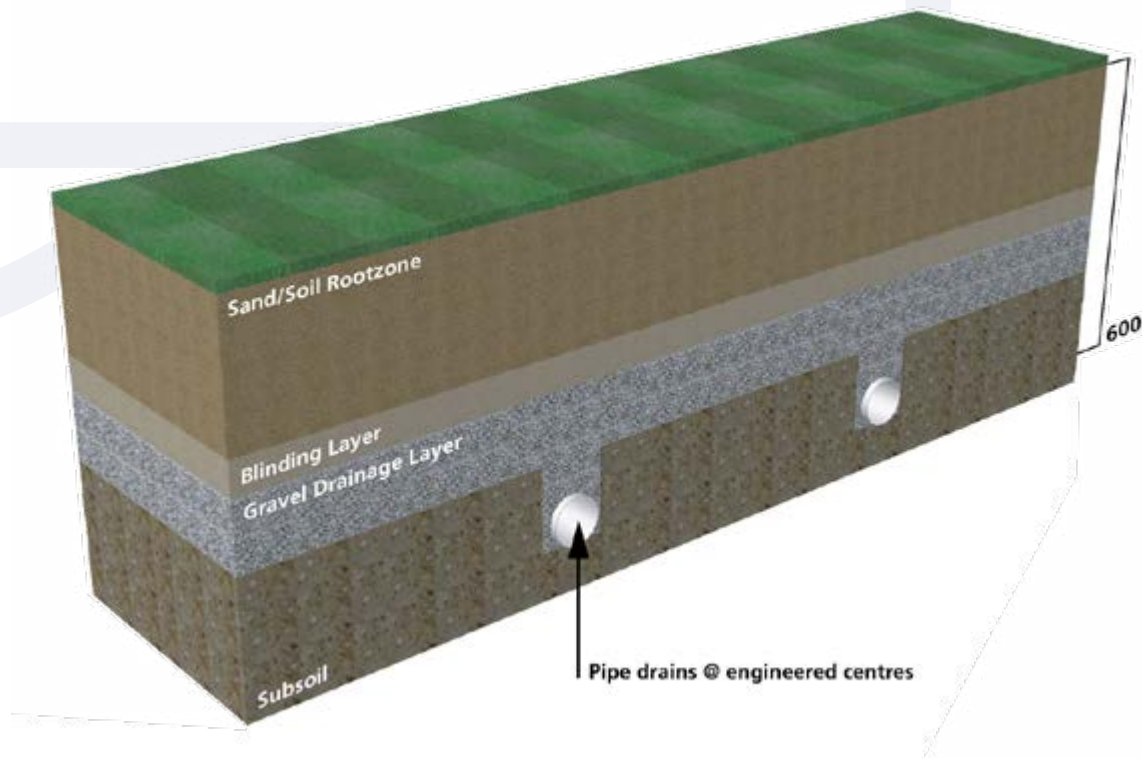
Profil d'un terrain avec zone d'enracinement sablonneuse sur couche de drainage en gravier
